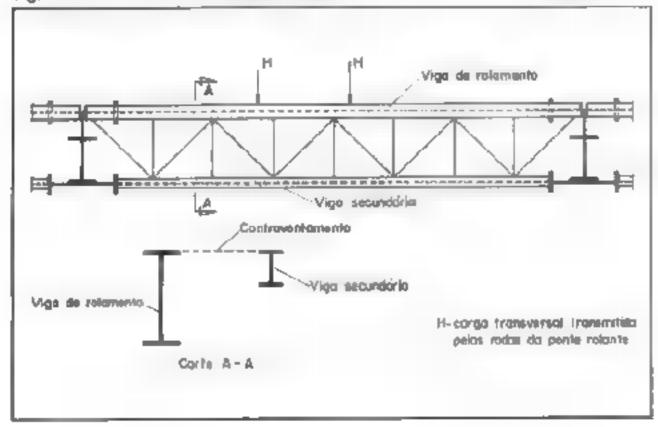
CONTRAVENTAMENTOS LONGITUDINAIS
